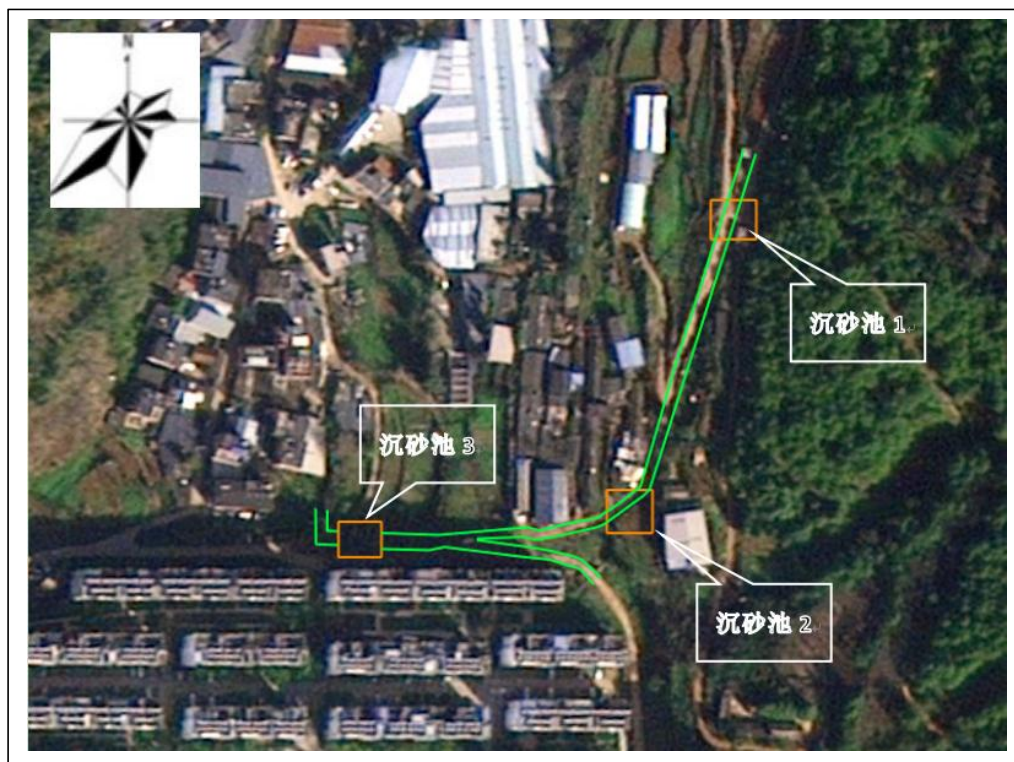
翡翠花园北侧截洪沟和沉砂池平面布置图
